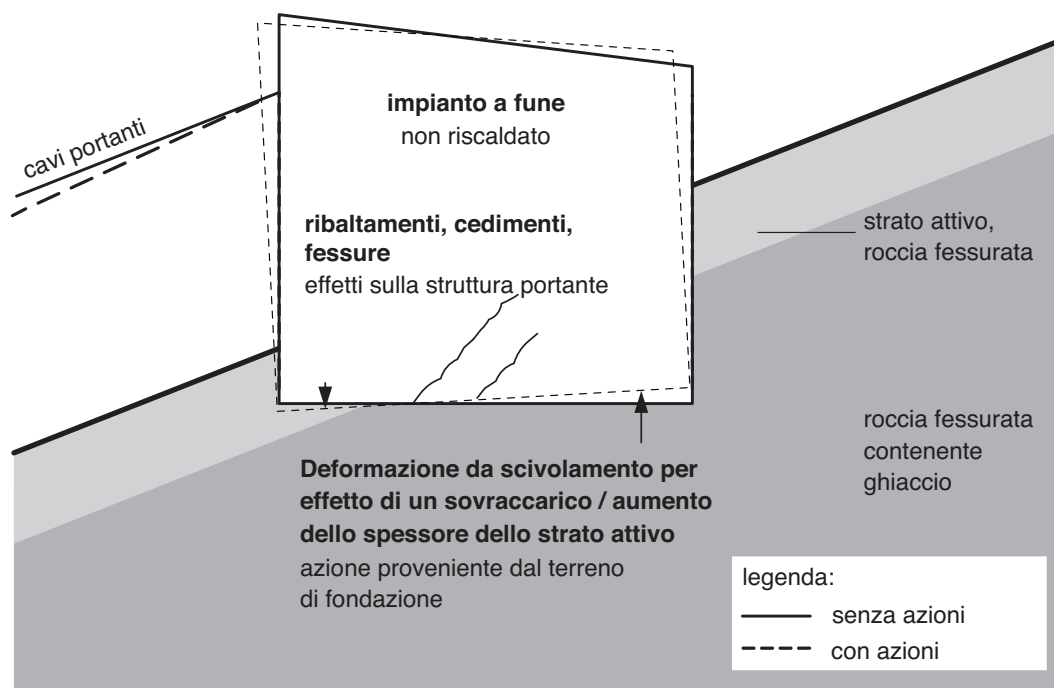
Rappresentazione schematica di un impianto a fune fondato su una roccia fessurata contenente ghiaccio e soggetta a una sollecitazione o a un effetto proveniente dal terreno di fondazione.
